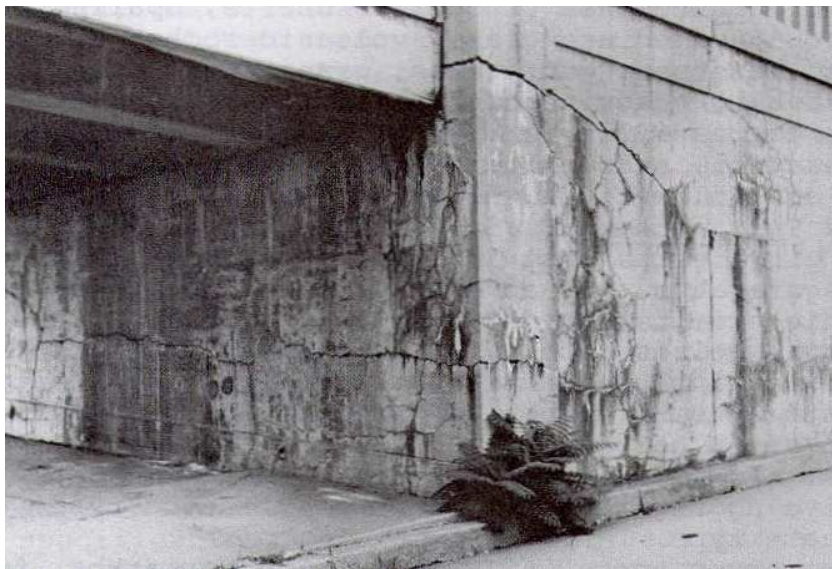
Deterioração do betão por reacções álcalis-sílica reactiva (Sousa Coutinho, 2006).
